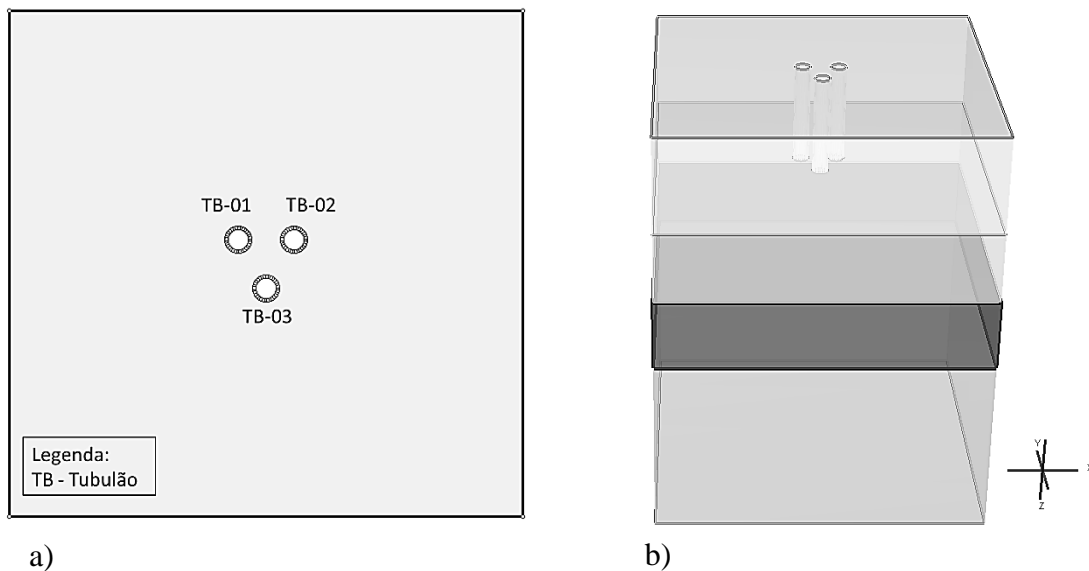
Escavação dos tubulões. a) Planta; b) Perspectiva.
